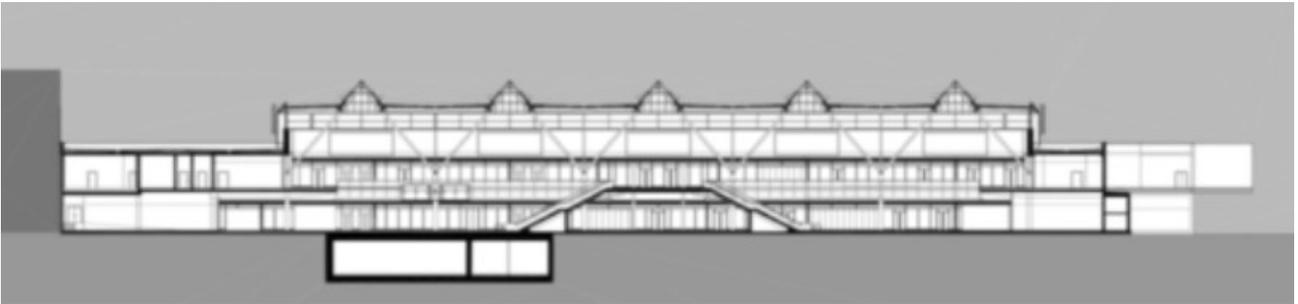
Sezione del progetto della nuova stazione di Linz, Austria, ad opera dell' architetto Wilhelm Holzbauer
